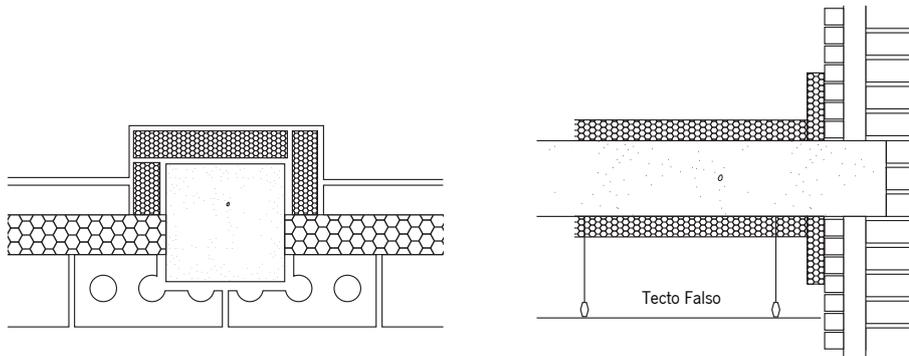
Correção de Ponte Térmica pelo interior em zona de pilar & Zona corrente de alvenaria e na ligação entre a parede e laje de piso intermédio como isolamento
